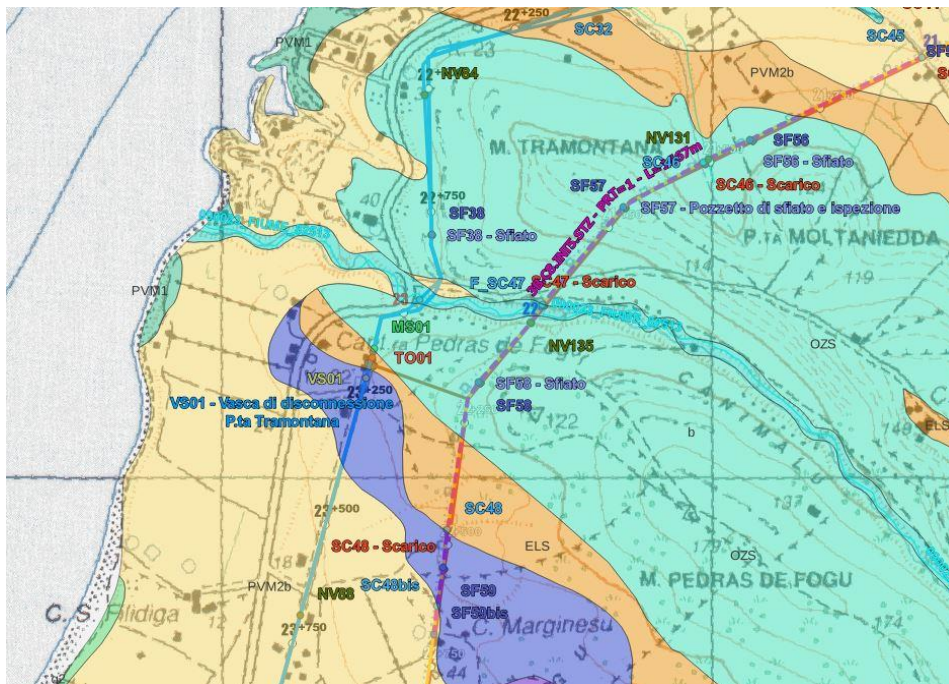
dettaglio dello attraversamento in sub alveo dell’elemento idrico Strahler 82473.
